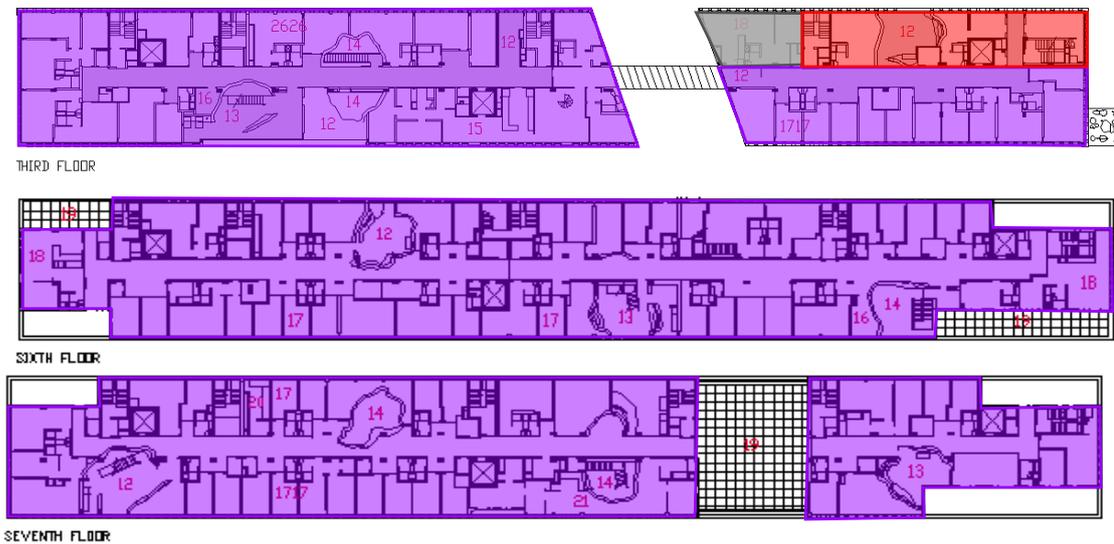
Zonificación 3ra, 6ta y 7ma Planta- Residencia Simmons Hall. Fuente: Propia
